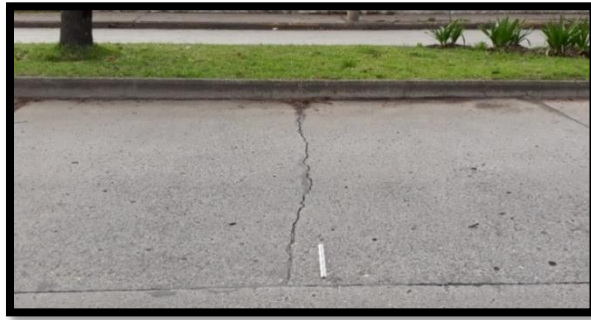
Grieta de ancho menor a 10 mm (Tramo 1).
